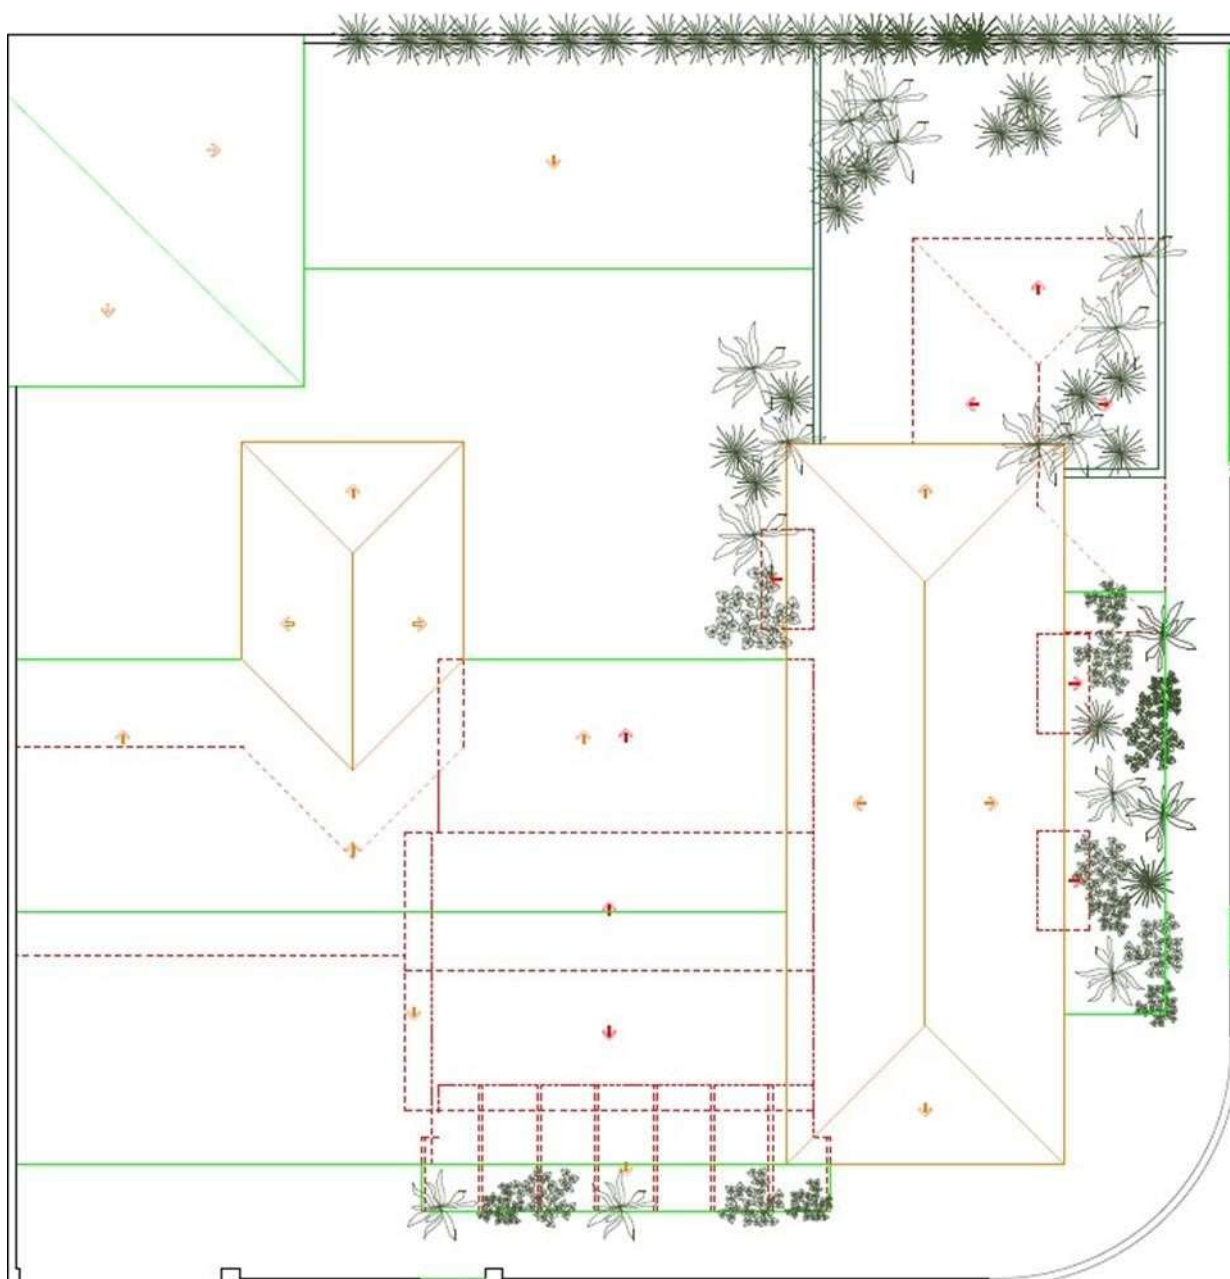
nova planta de cobertura, indicando em verde as estruturas novas, em vermelho tracejado o que será suprimido/alterado e em laranja as estruturas mantidas.
